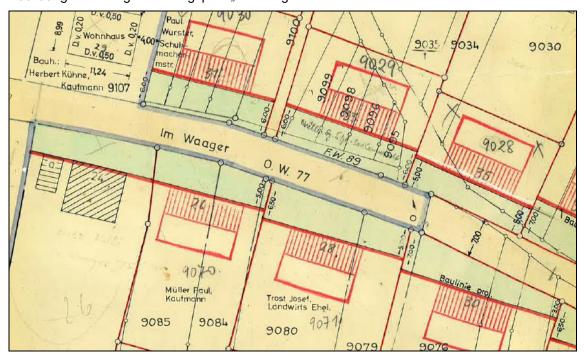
Auszug Bebauungsplan "Im Waager – Panoramastraße"
